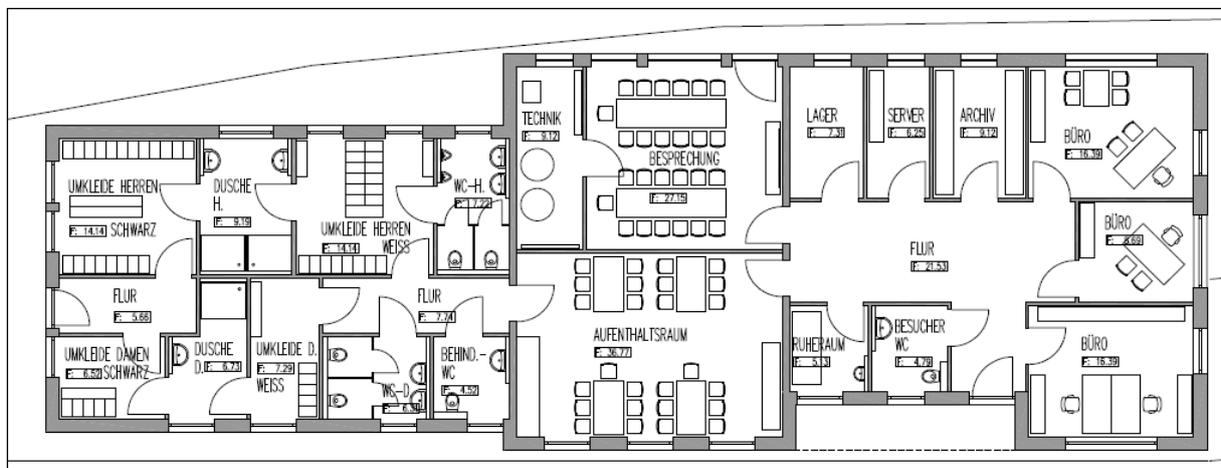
Vorentwurf eines eingeschossigen Betriebsgebäudes (Maße siehe Plan in der Anlage zum Bericht)
